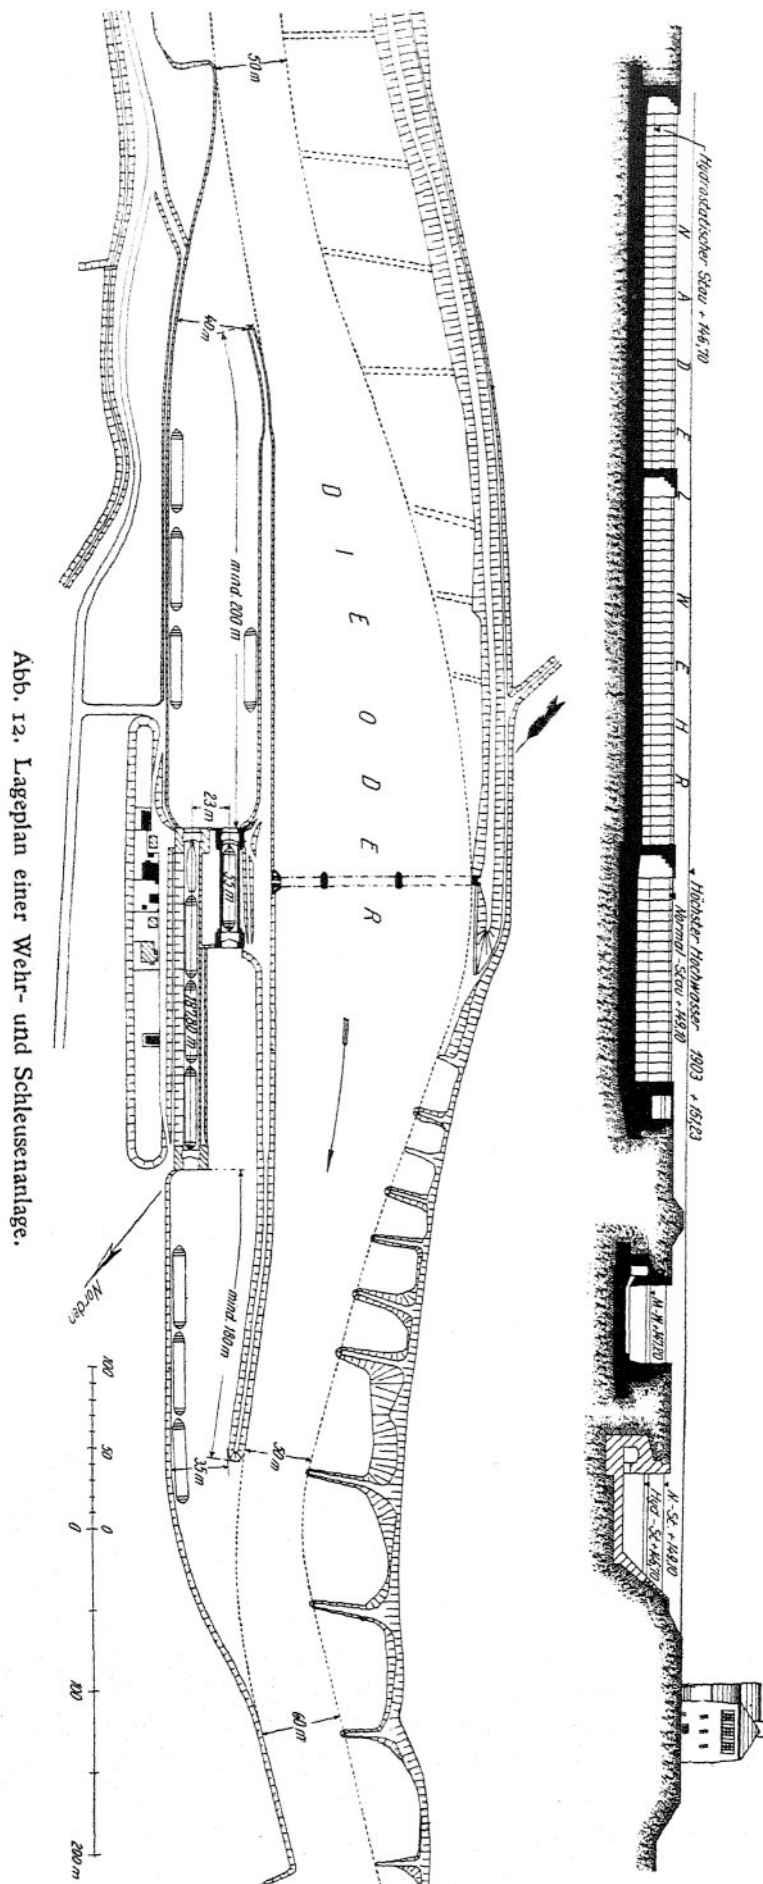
Lageplan einer Wehr- und Schleusenanlage.
